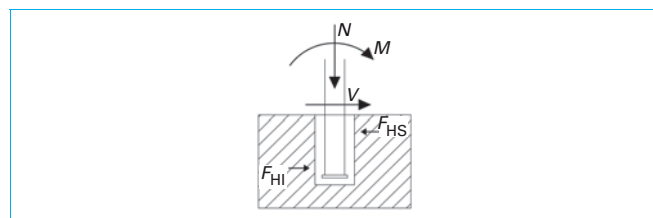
Assemblage du pied de poteau à la fondation réalisé grâce à un logement prévu dans le béton (d'après [9])
